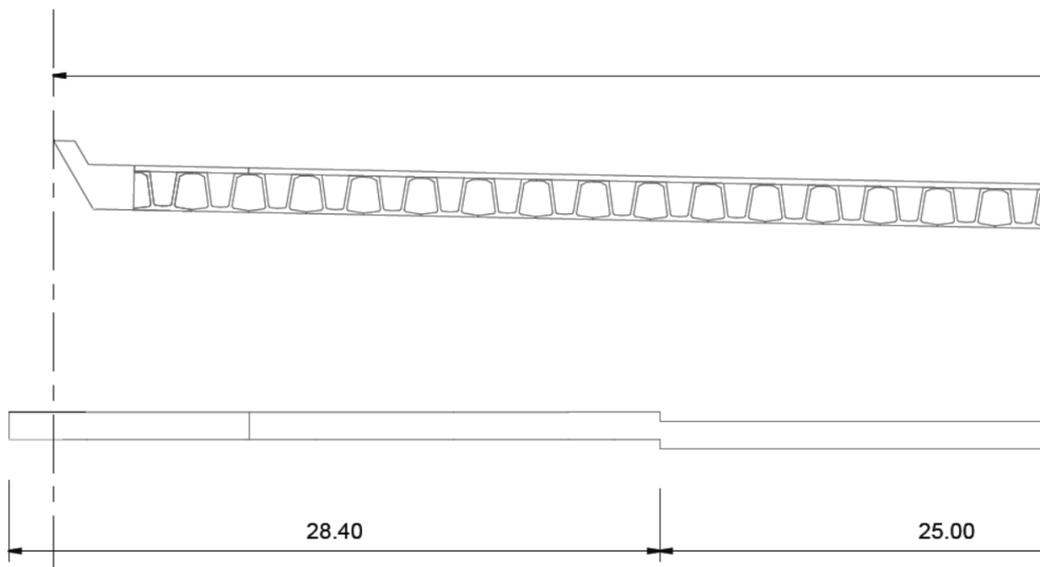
Profilo longitudinale in prossimità dell'imbocco
